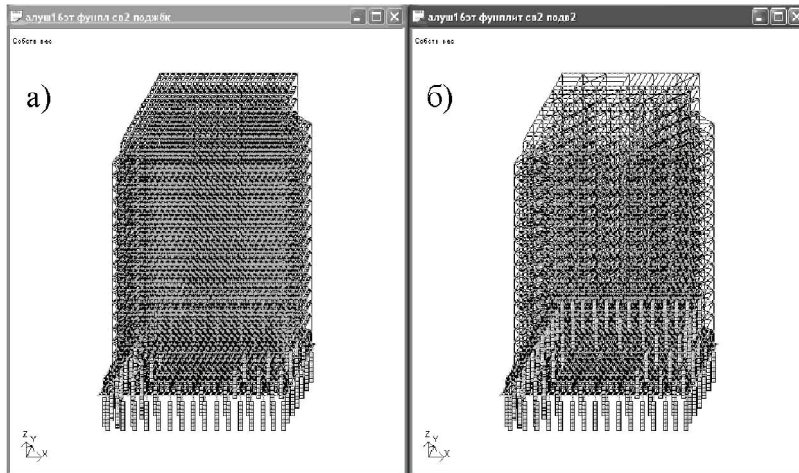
Расчетные схемы здания: а – железобетонный каркас; б – металлический каркас.
